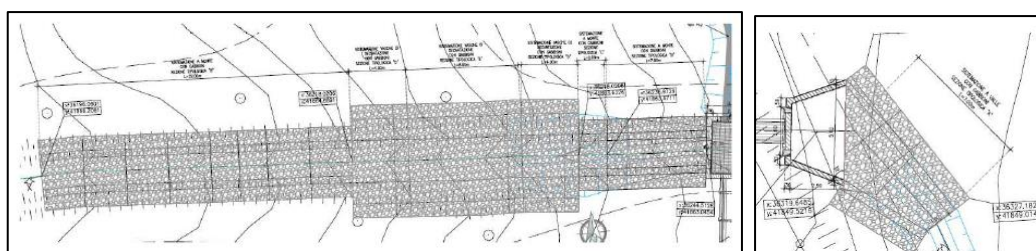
Stralcio planimetrico inalveazione a monte e a valle
